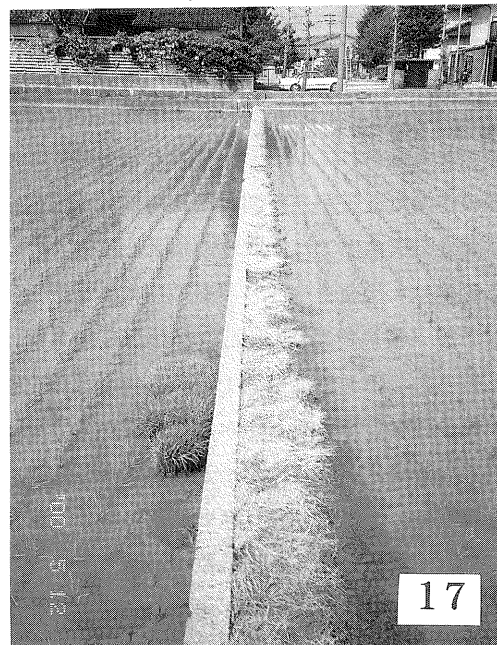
コンクリート畦畔と土畦畔の2重構造畦畔（石川県松任市）
